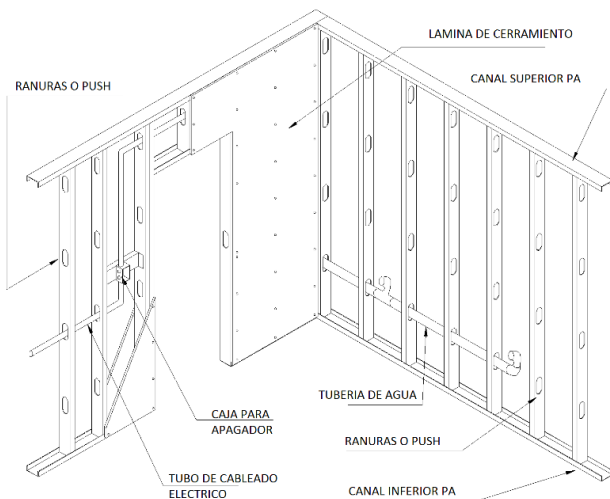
, Elementos de unión de paneles. (Fuente: propia del autor).
